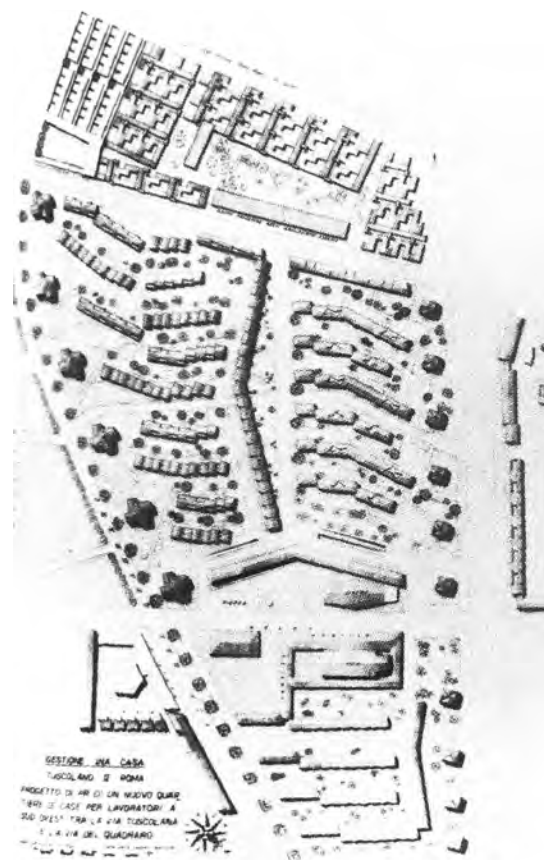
Planimetria originale del Tuscolano III (Fonte: Archivio storico INA).
